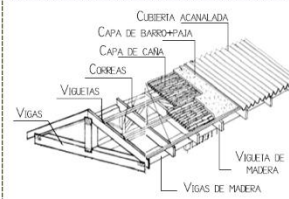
Sistema constructivo de quincha, materialidad y técnicas constructivas del centro poblado. Fuente: Propia.
